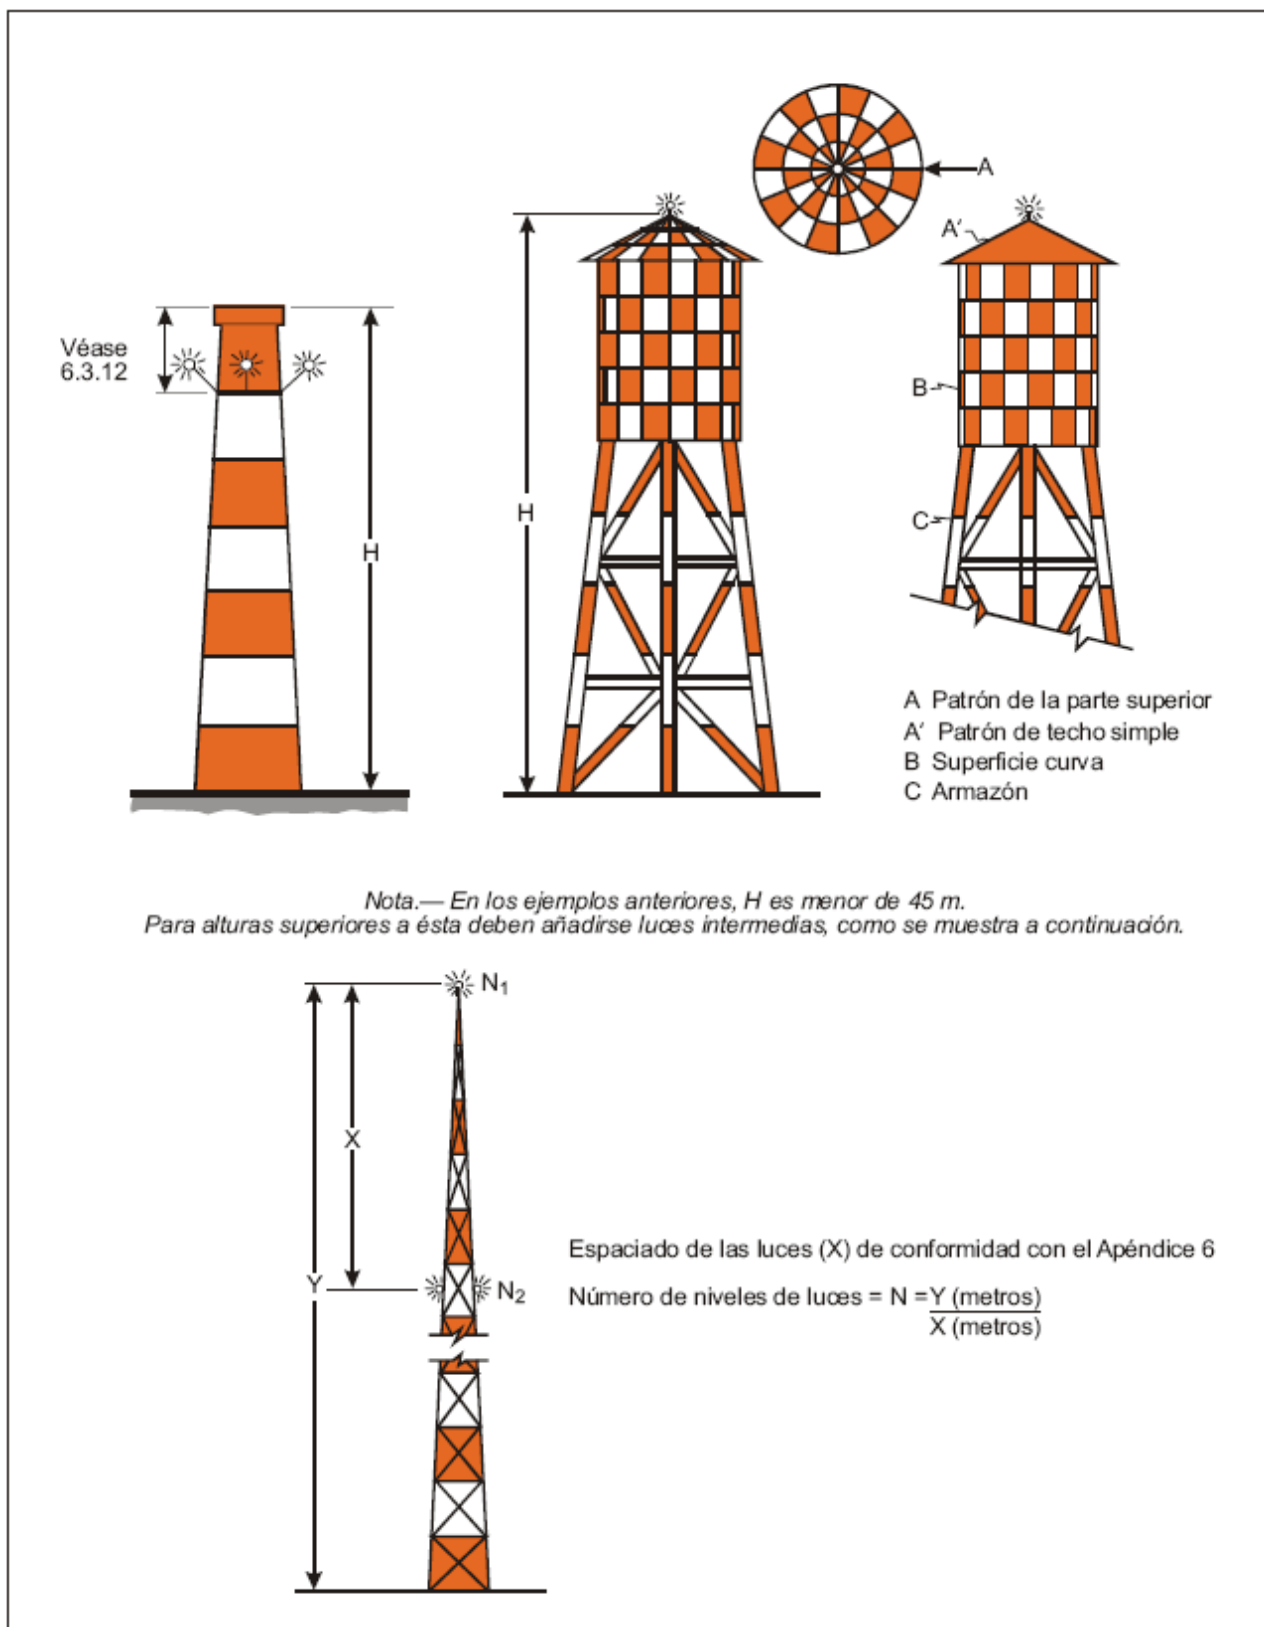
Ejemplos de señalamiento e iluminación de estructuras elevadas
